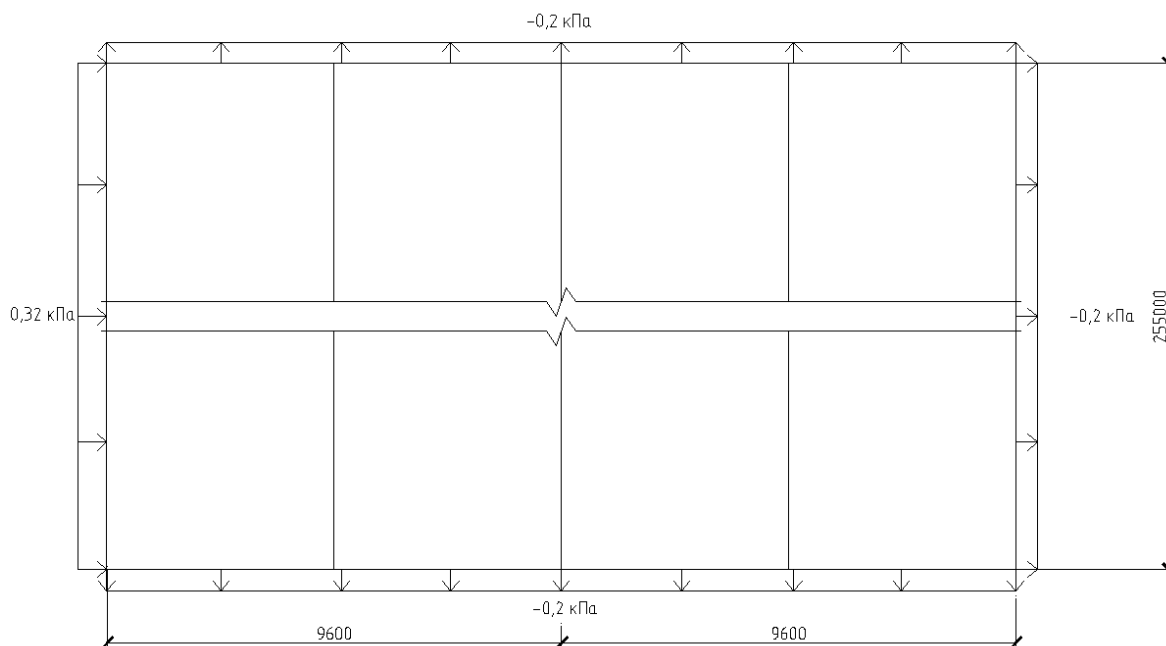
б – Расчетная схема для сбора ветровой нагрузки
